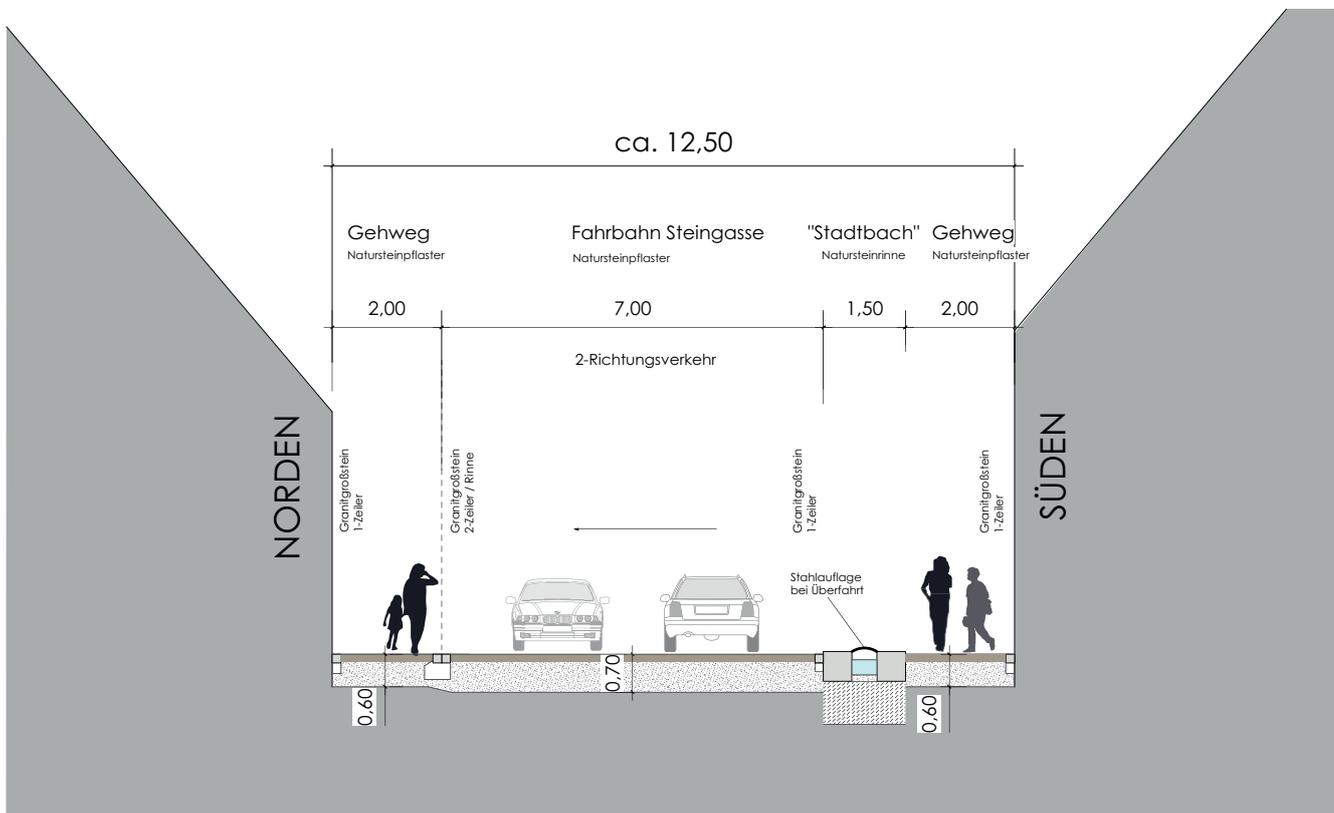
Gestaltungsschnitt Steingasse (o.M., Entwurf und Zeichnung LAB RÖTH)
